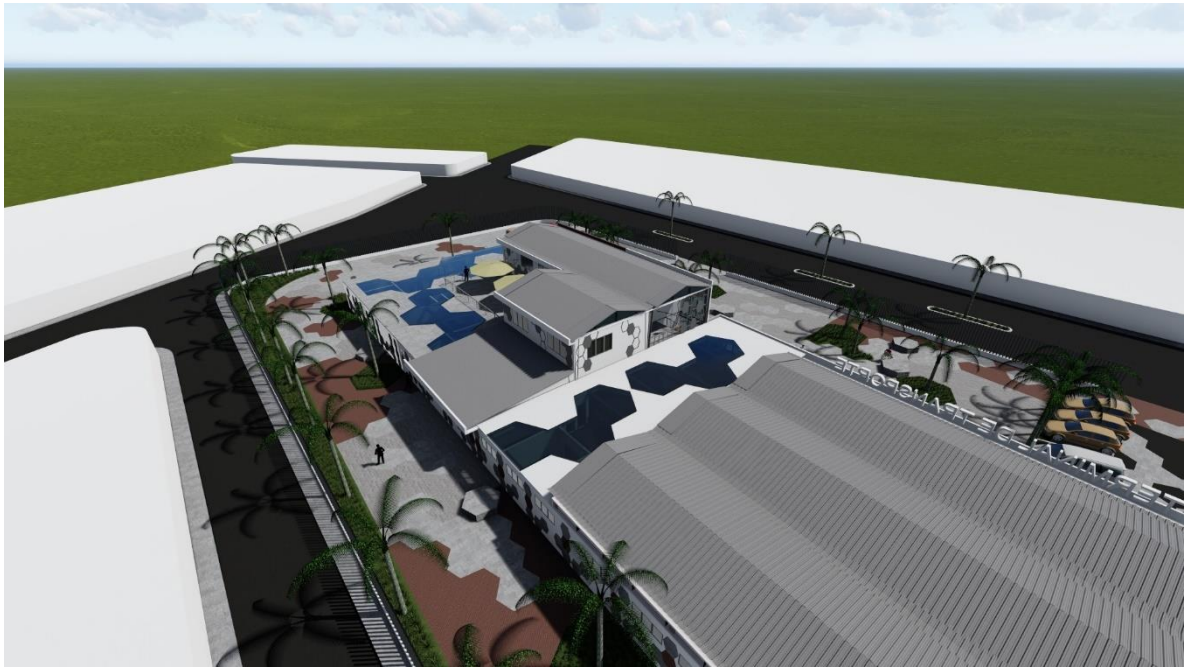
Renders proyecto terminal de transporte El Banco, Fuente: elaboración propia.
